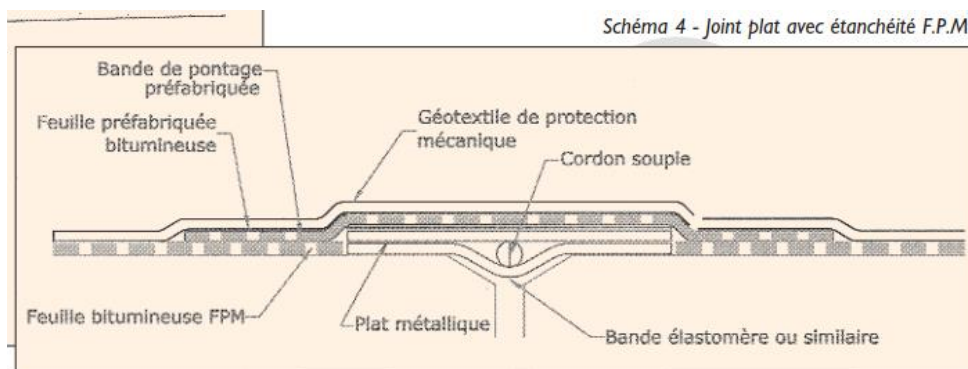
Traitement du joint entre deux éléments préfabriqués
